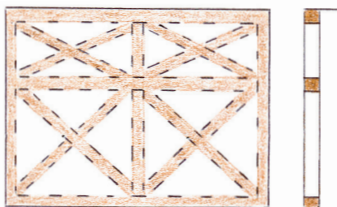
Elévation et section : Ossature en bois avec parement en maçonnerie.
